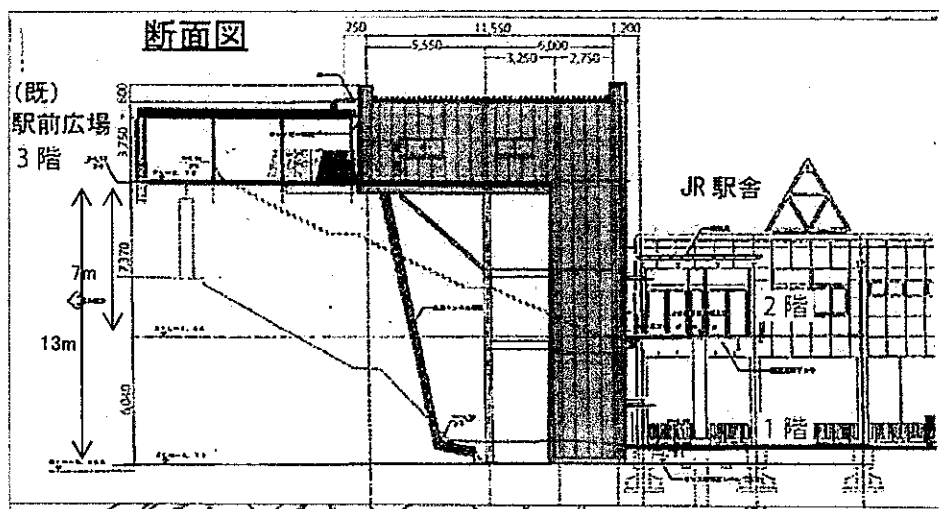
JR 西宮名塩駅 エレベーター設置 断面図
